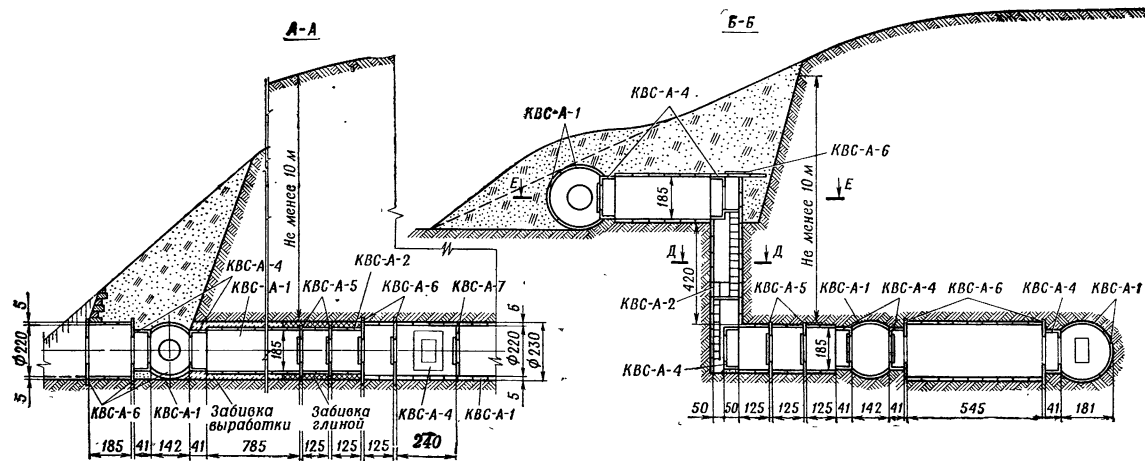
Сборное железобетонное сооружение УСБ (разрезы)
